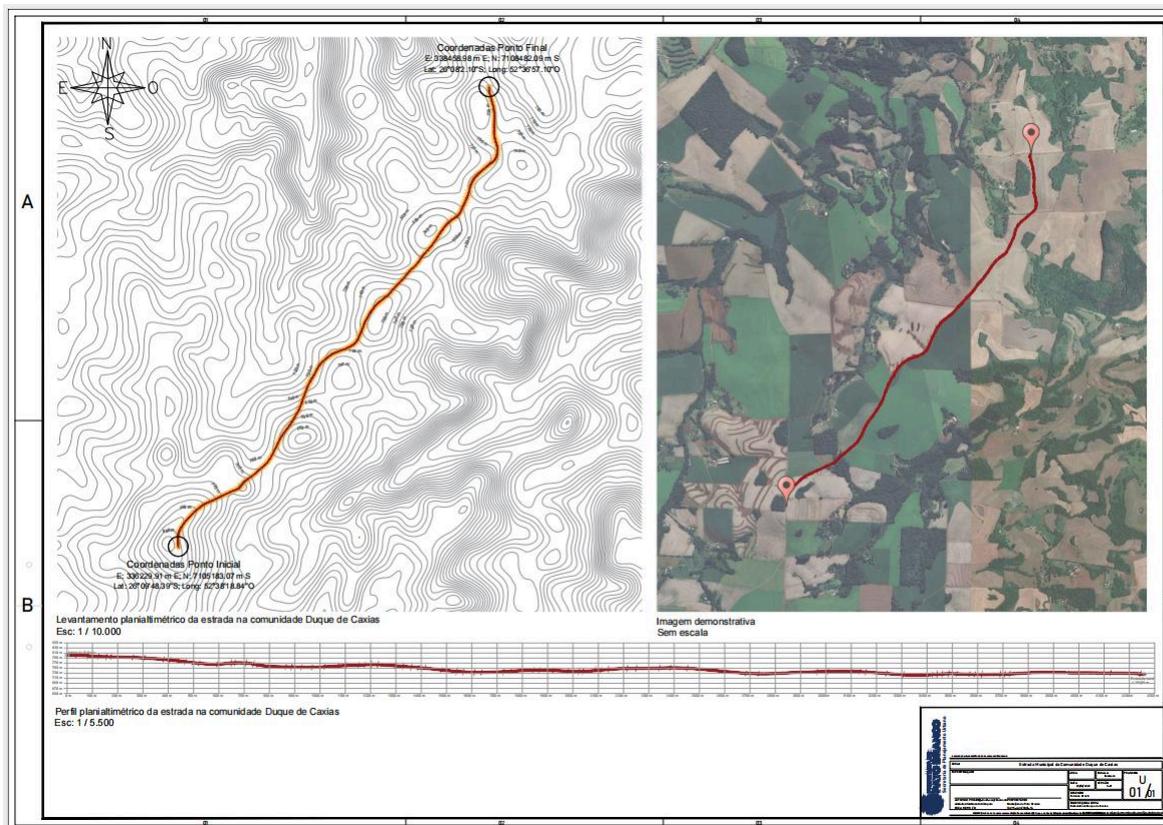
Localização do trecho onde pretende-se implantar a pavimentação em concreto betuminoso.
